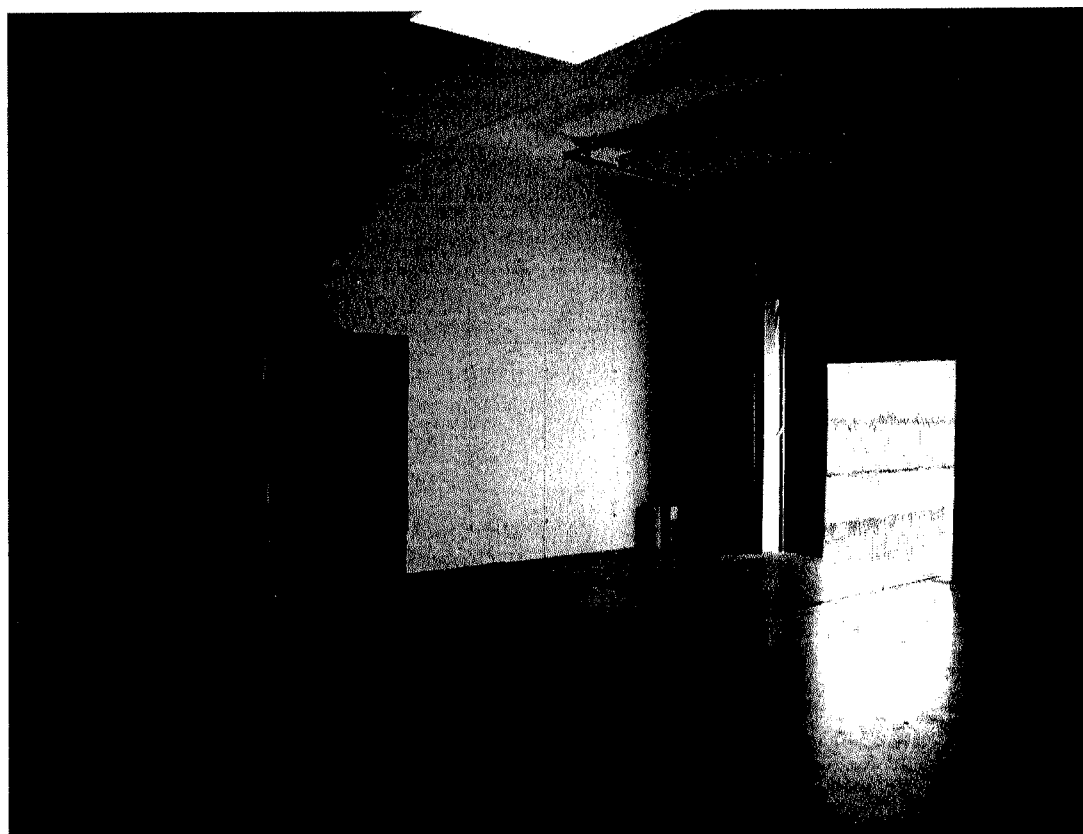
vista interna piano terra (lato est, visto da nord)
